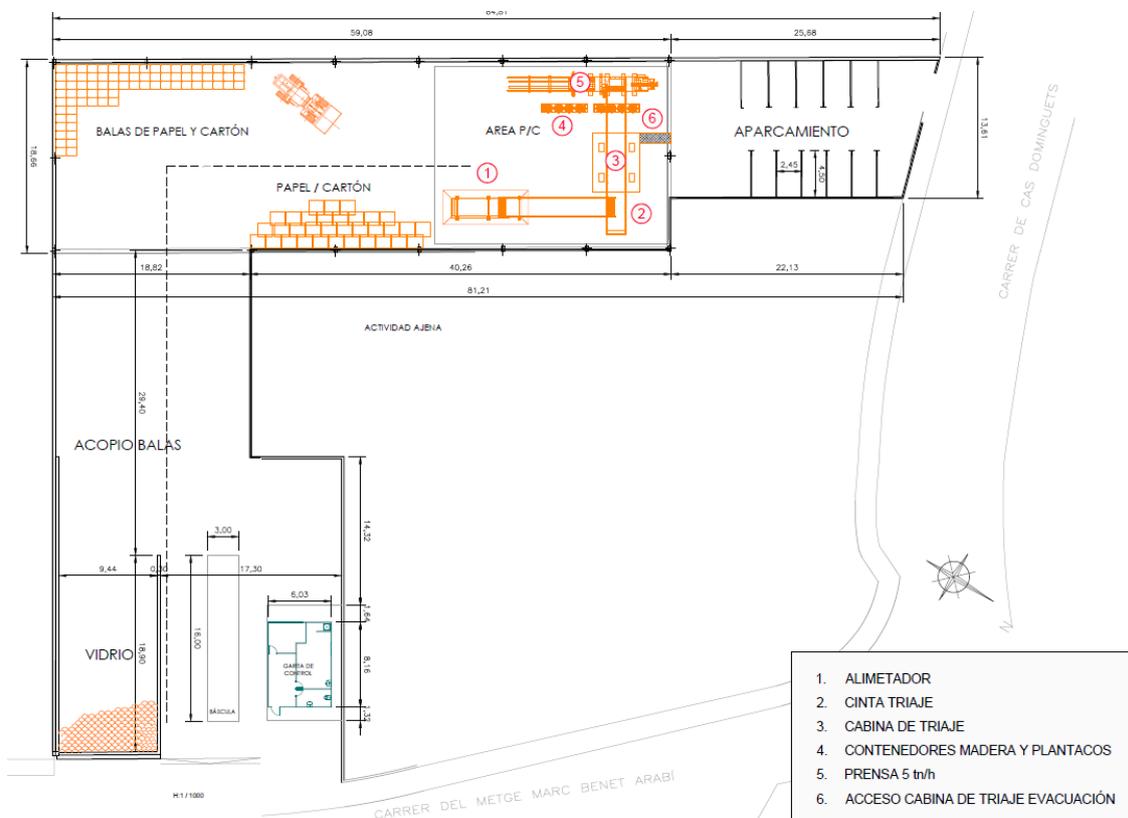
Planta general propuesta de estación de transferencia alternativa n°1
